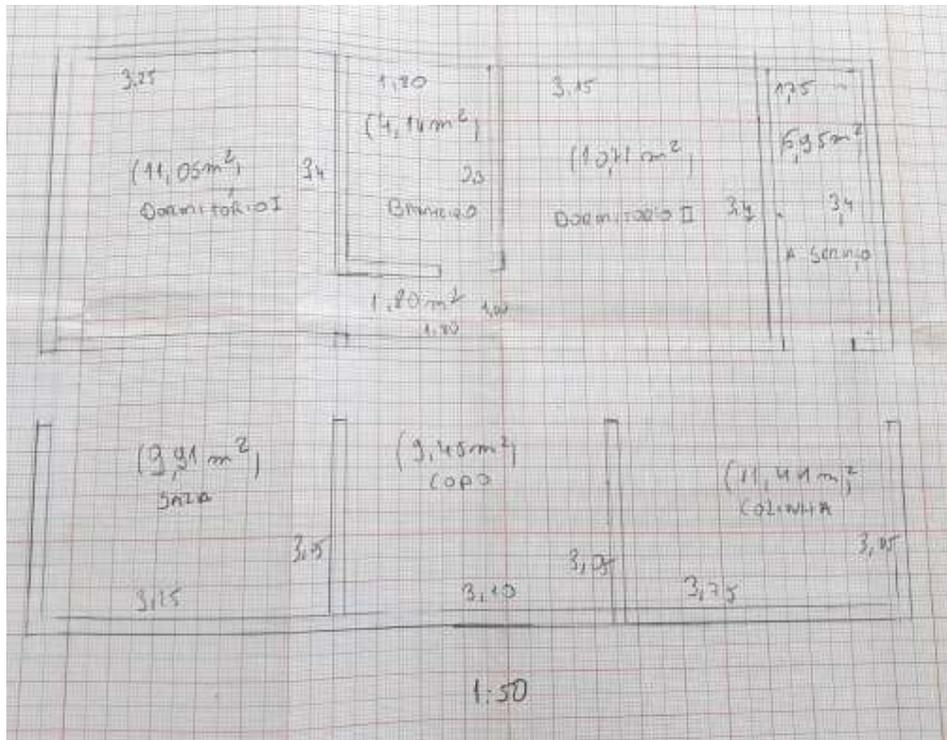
Extrato 1 do E7 Planta Baixa no papel quadriculado
